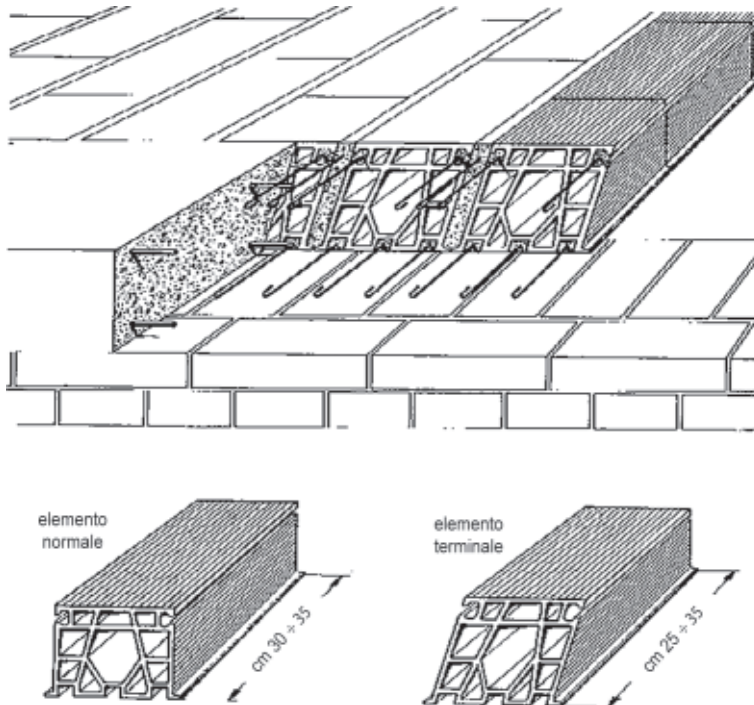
Solaio con travetti portanti in laterizio. Nelle realizzazioni iniziali armati con acciaio da 4 mm
